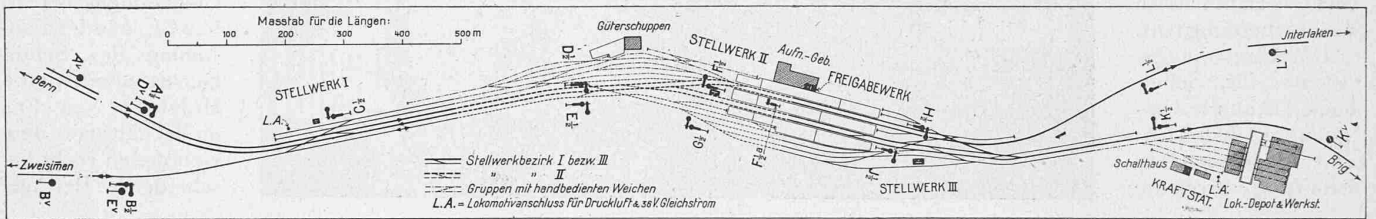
Schematischer Lageplan des Bahnhofes Spiez der Lötschbergbahn.
